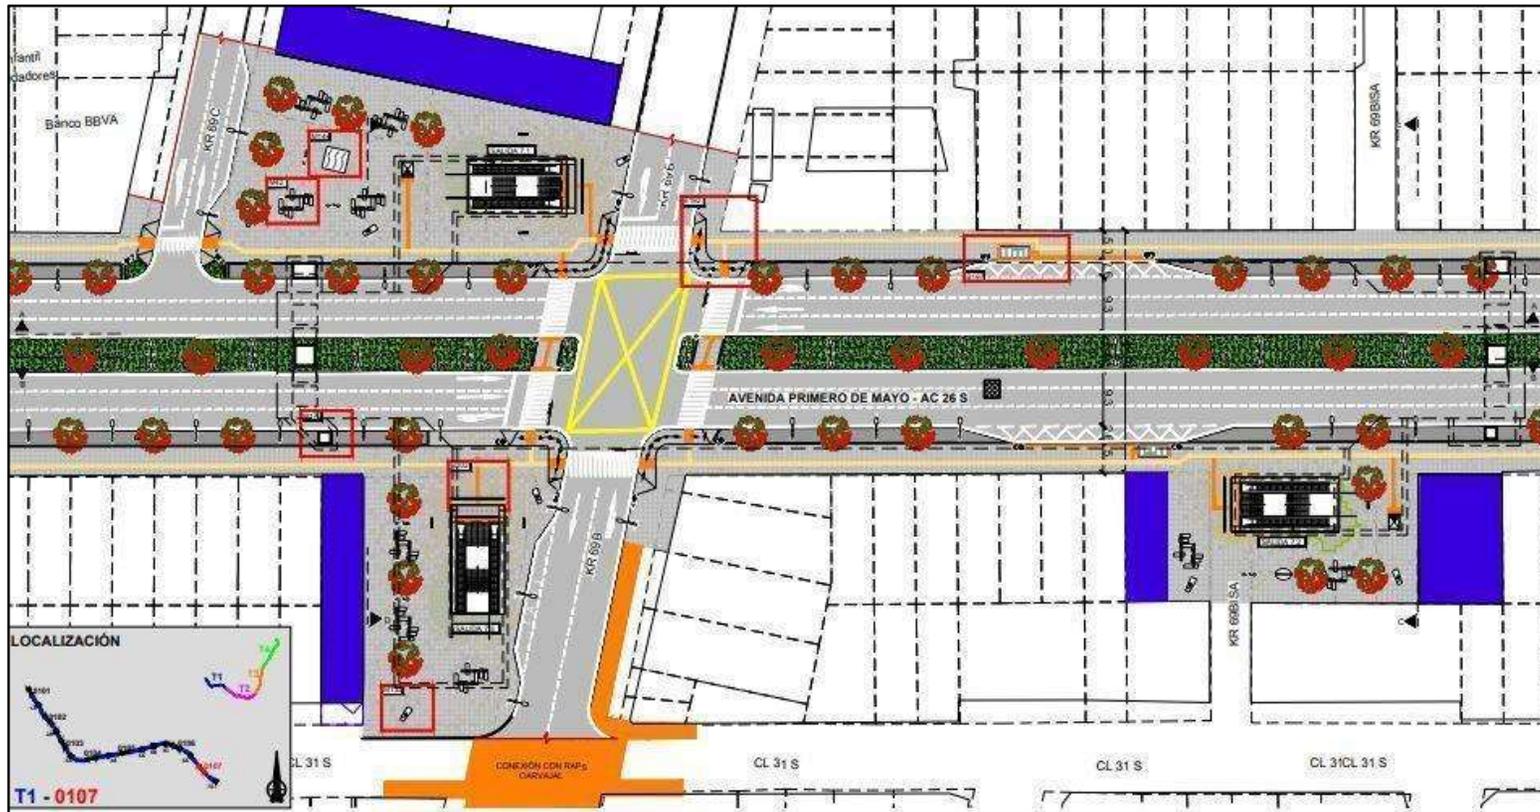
Planta general propuesta, Estación Primero de Mayo.
